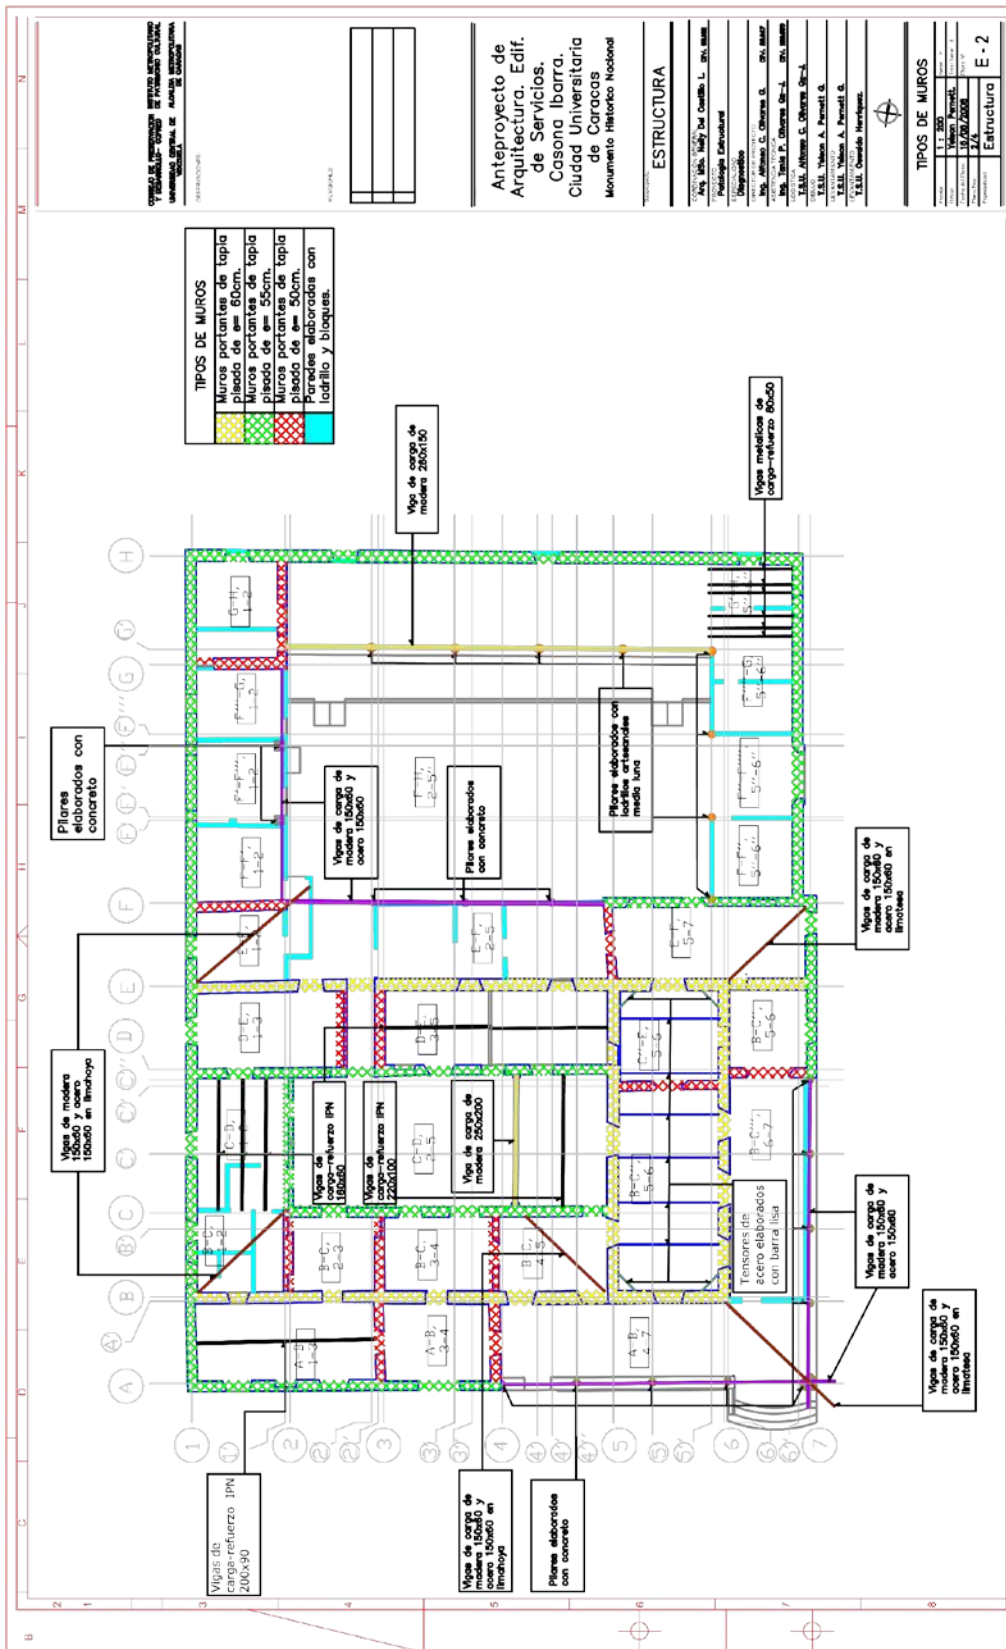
Plano con los tipos de paredes en la Casona (Del Castillo, 2008).
